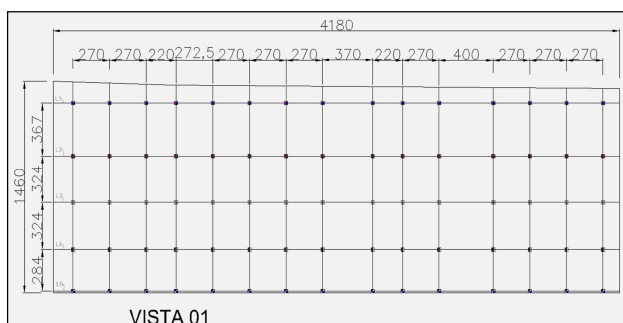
Vista 01 – Painel da cortina atirantada em estudo.
